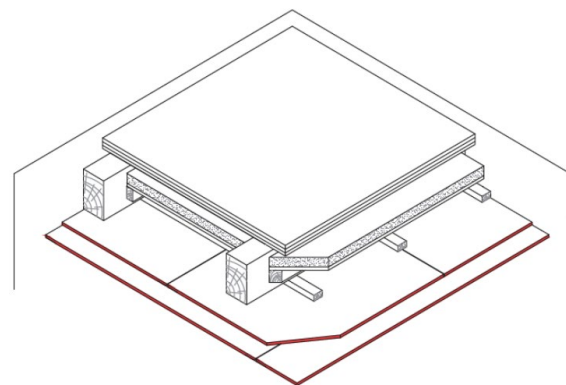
Holzbalkendecke F 30-B mit Deckenbekleidung und Estrich
